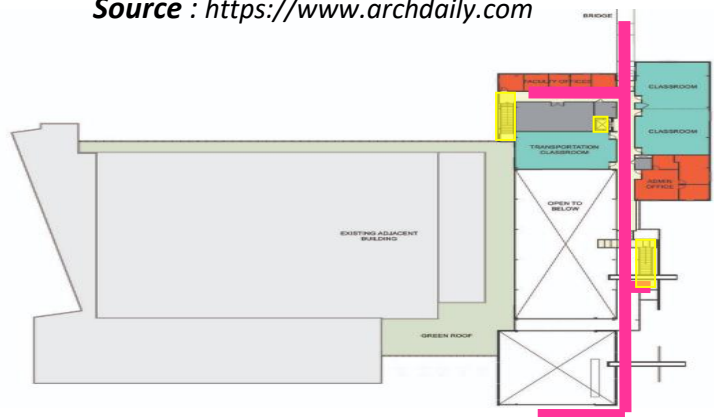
Plan de R+1 de Swenson Civil Engineering Building
